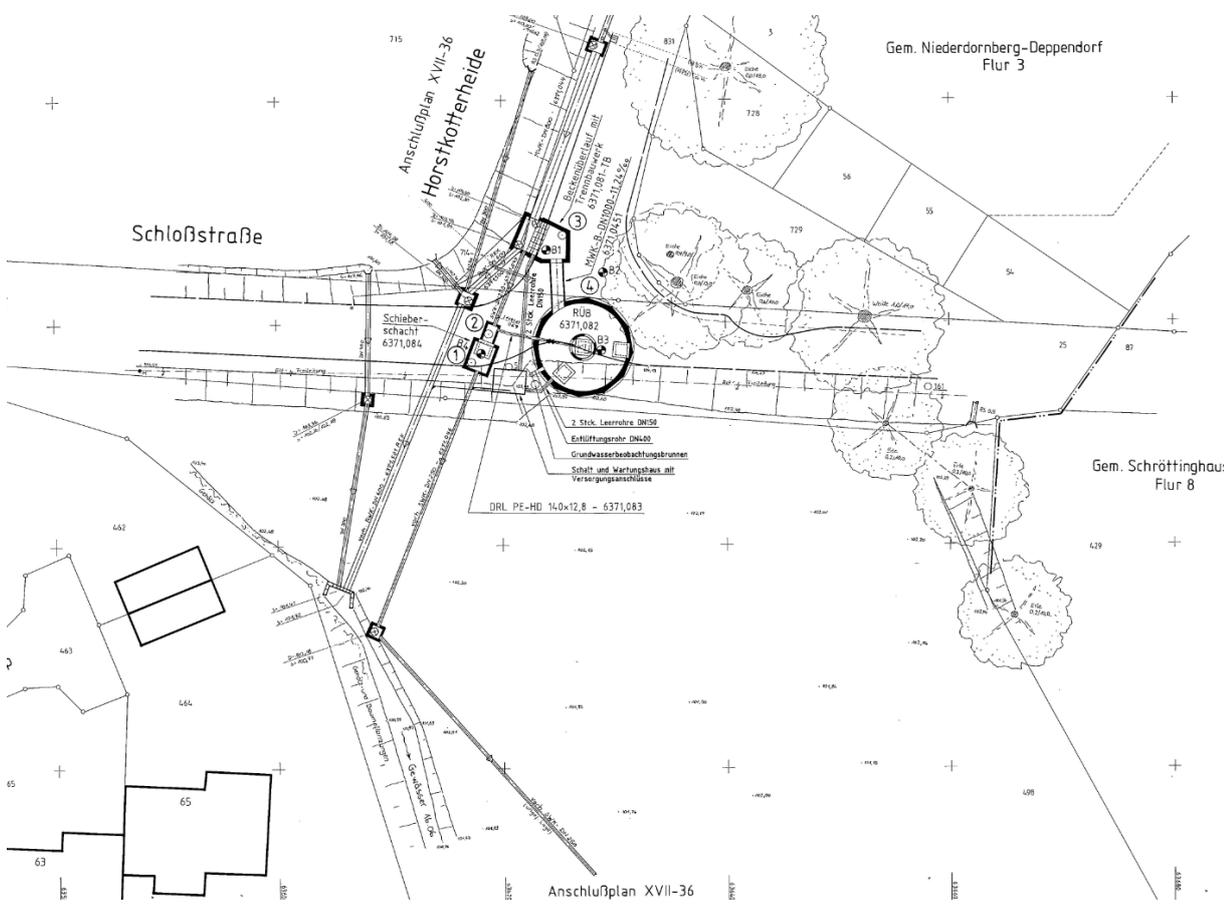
Lageplan des Bauwerks (Ausschnitt)
